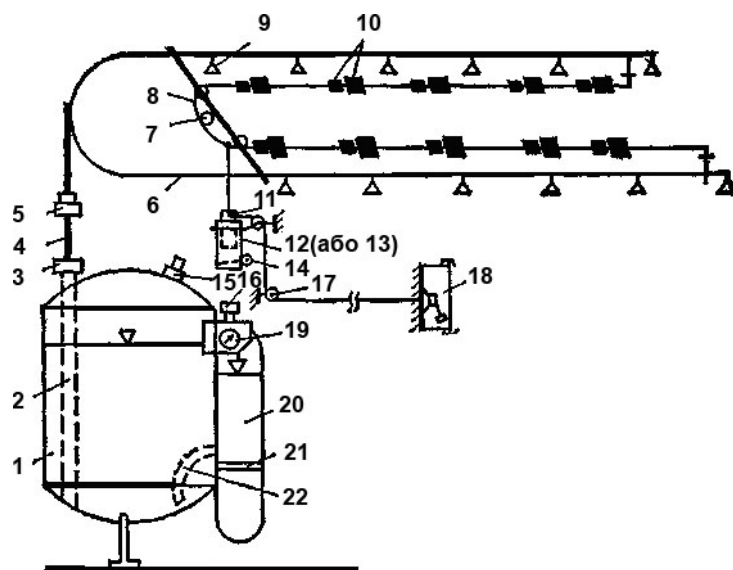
Принципова схема порошкової установки ОПА-250:
